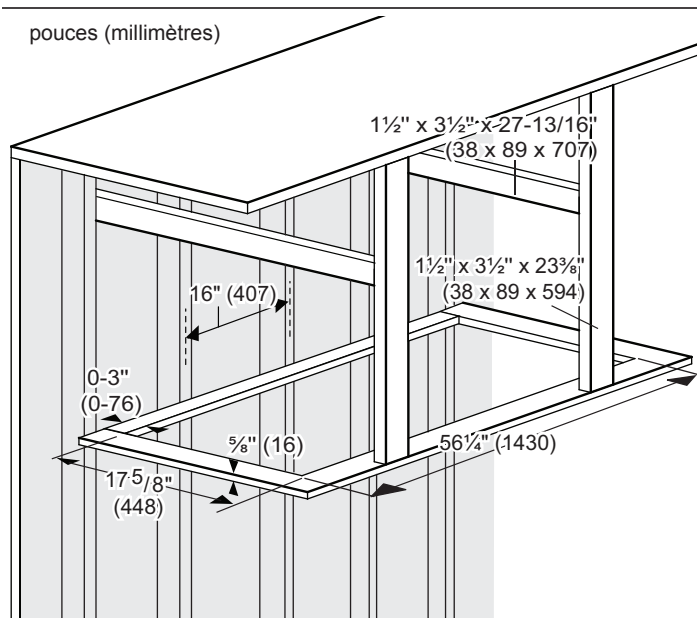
Dimensions des ouvertures pour le raccord et le tube
